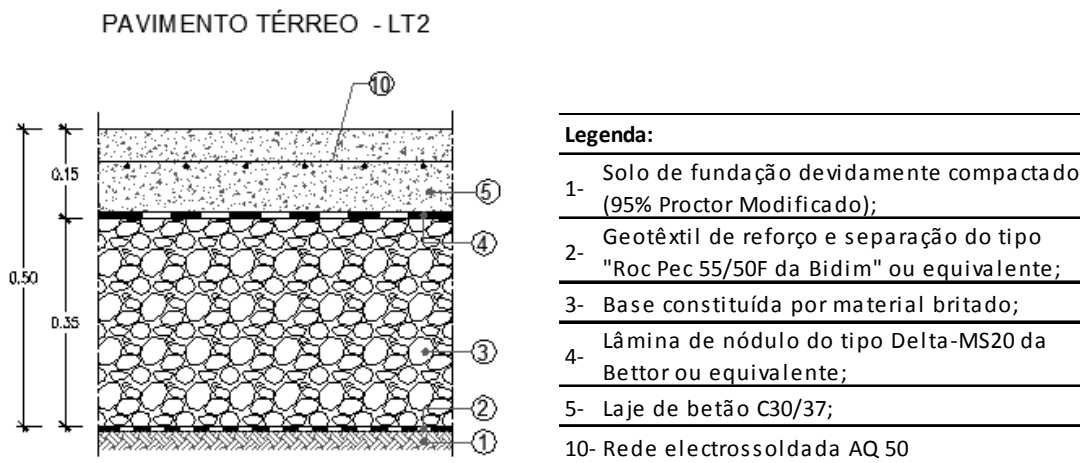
Corte tipo: Pavimento têrreo LT2.
